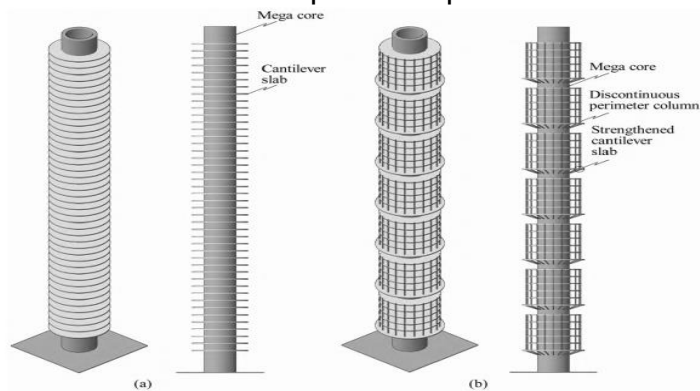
Dalles dans le système de méga-noyaux : (a) dalle en porte-à-faux, (b) dalle en porte-à-faux soutenue
